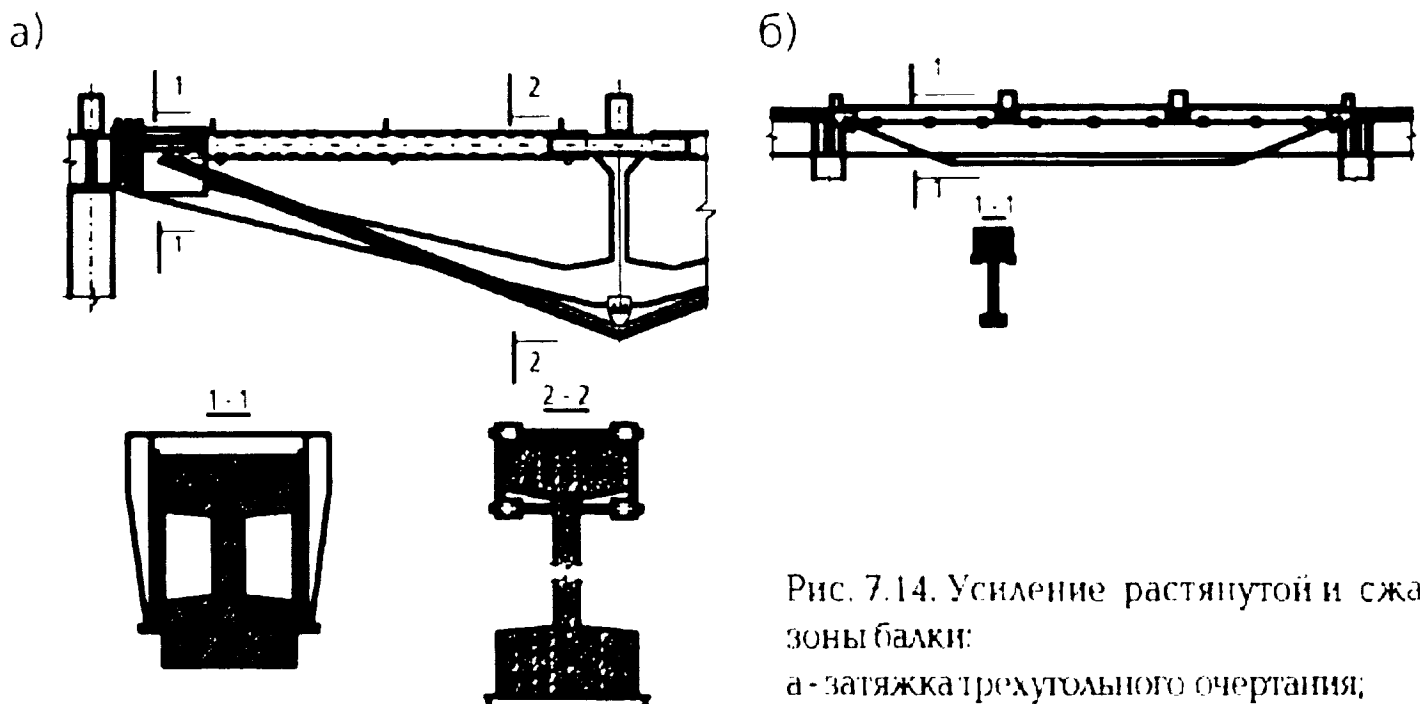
Усиление растянутой и сжатой зоны балки:
